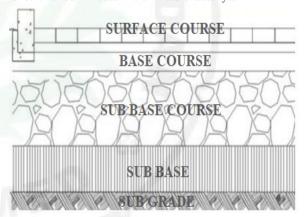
Rancangan Tampak Depan Desain Perkerasan Jalan.
